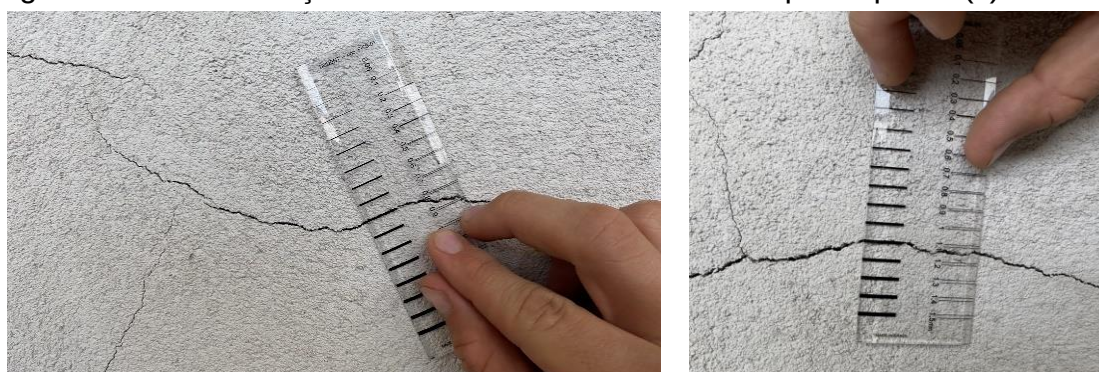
Identificação da abertura de fissuras do corpo de prova (b)
